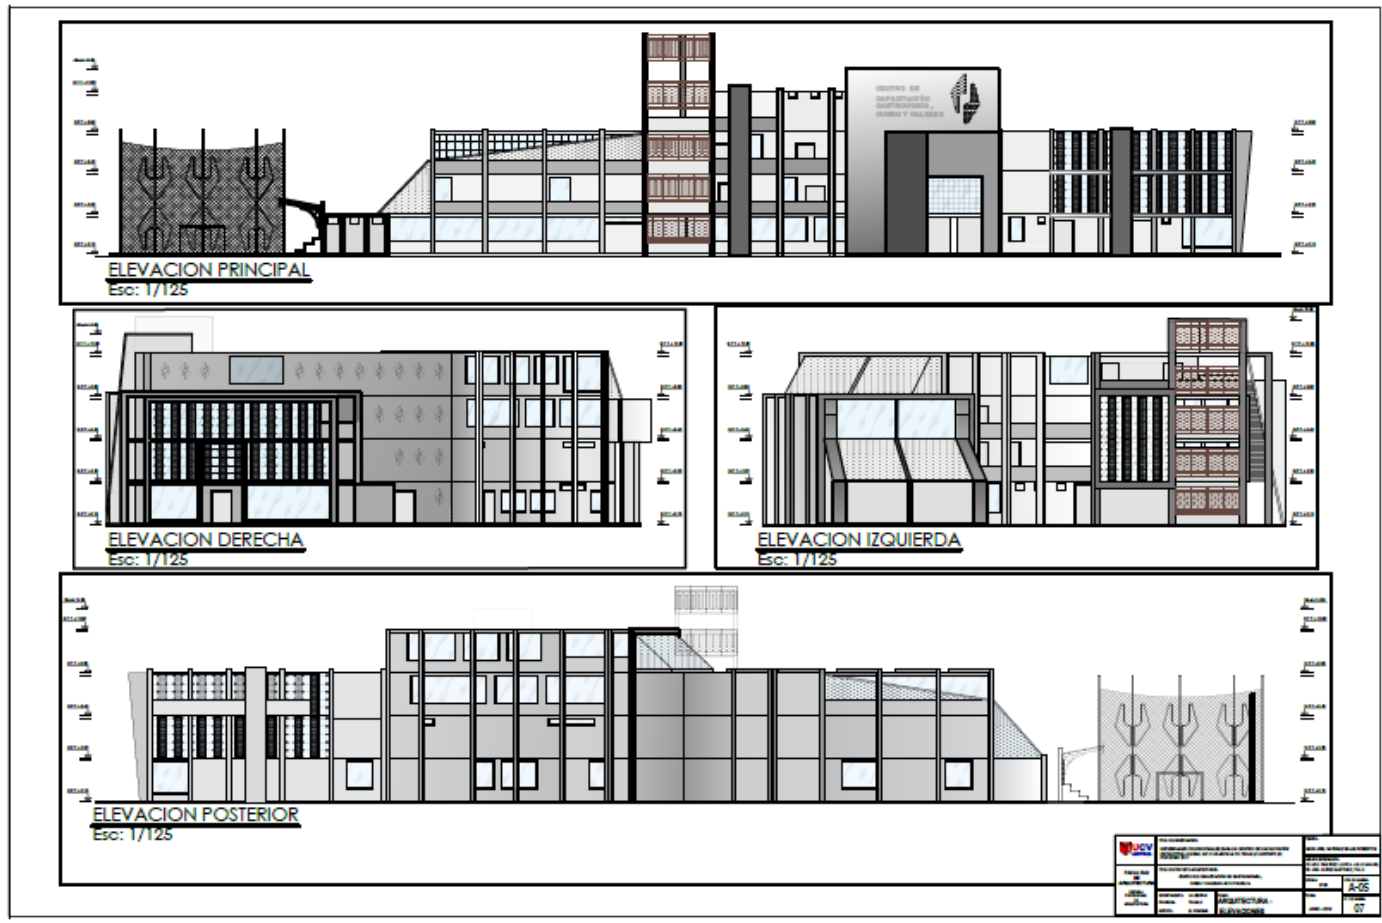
Plano de Arquitectura elevaciones -Plano N°07-Lámina A05
